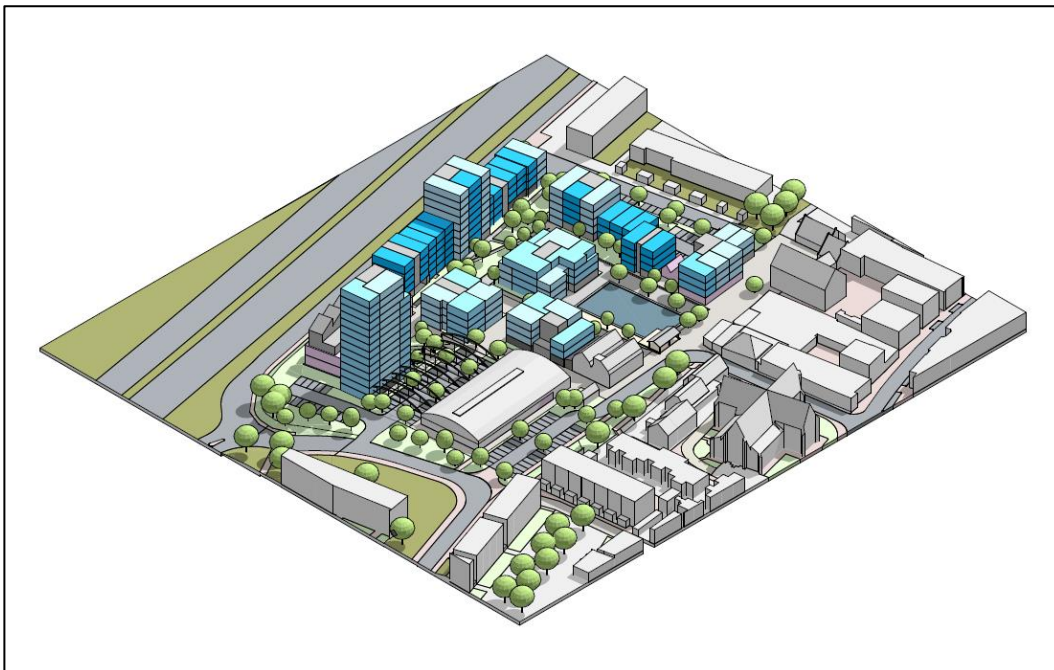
Globale ligging bouwplan Gedempte Haven
